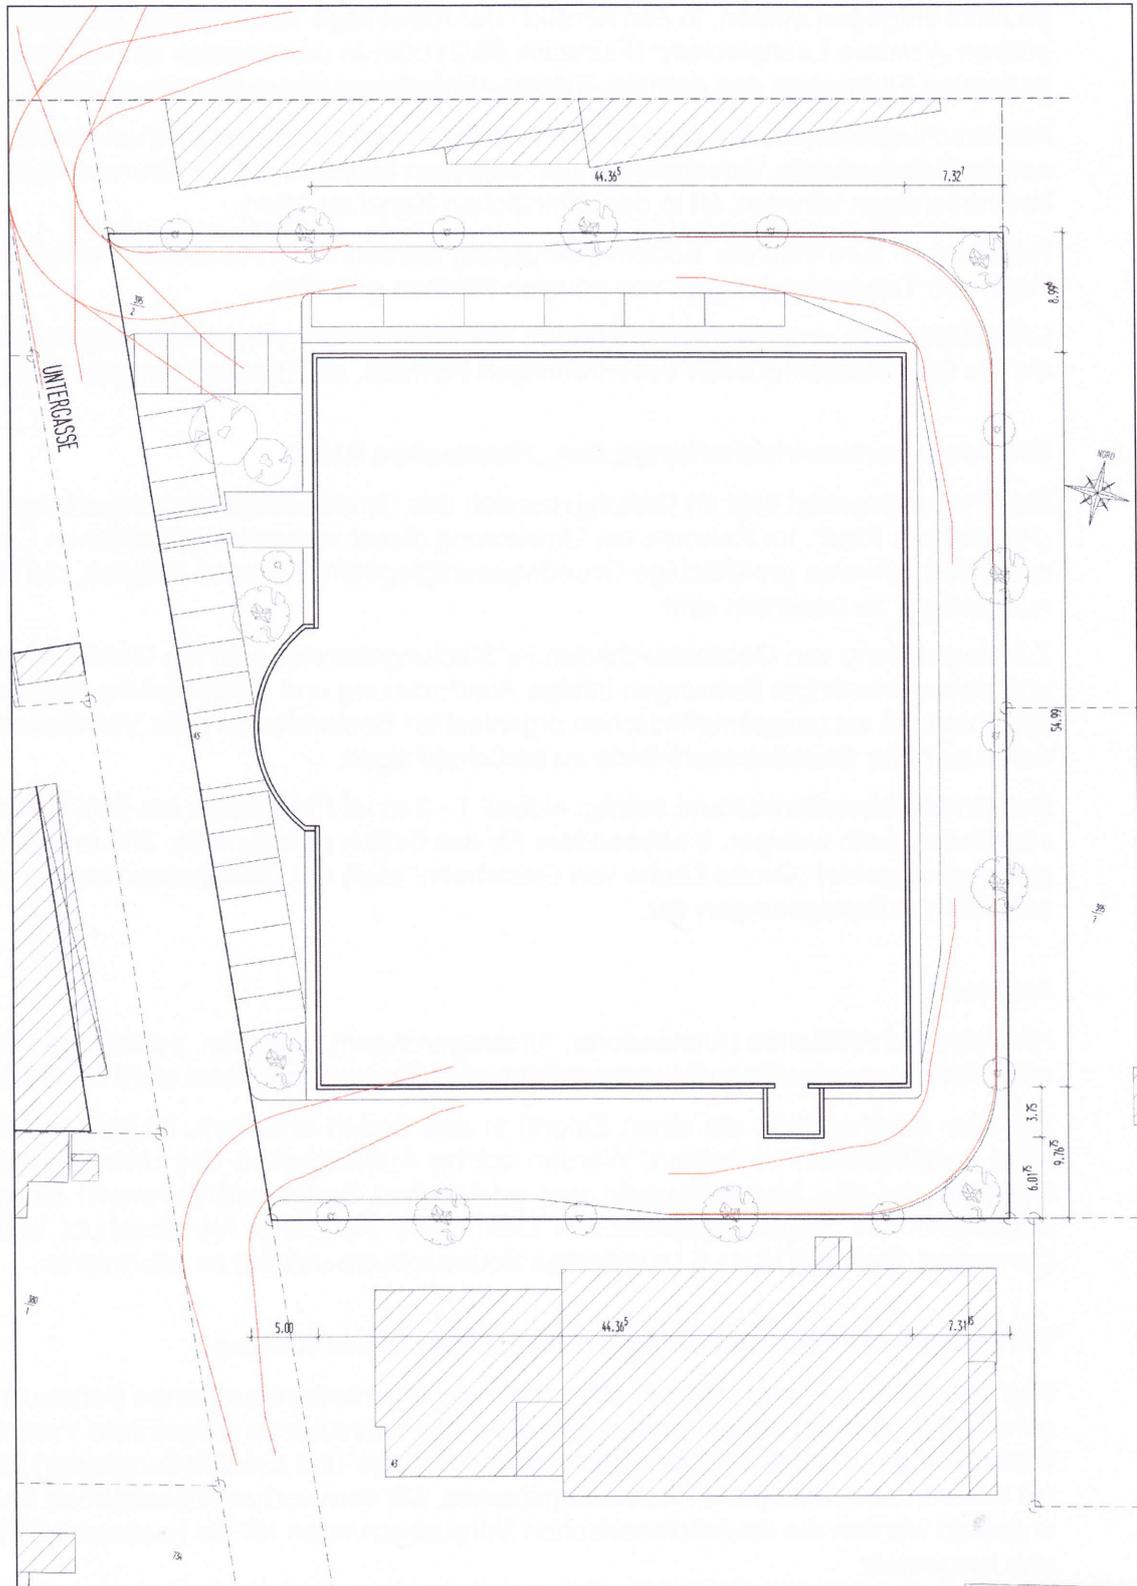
Lageplan Neubau Fa. Atotech, Standort Geinsheim (Planungsbüro Kehl 2010)
